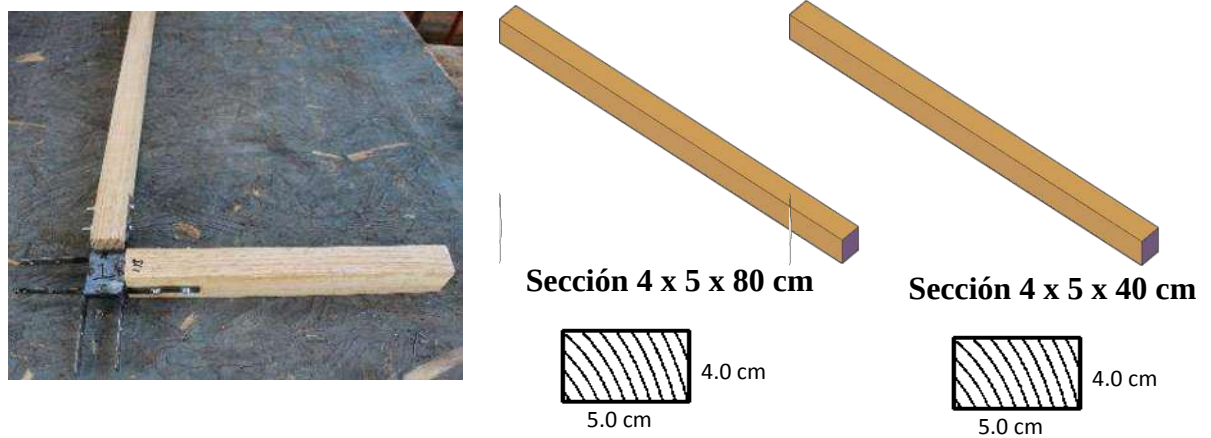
a) Pieza estructural de madera maciza armadas con conector metálico,
